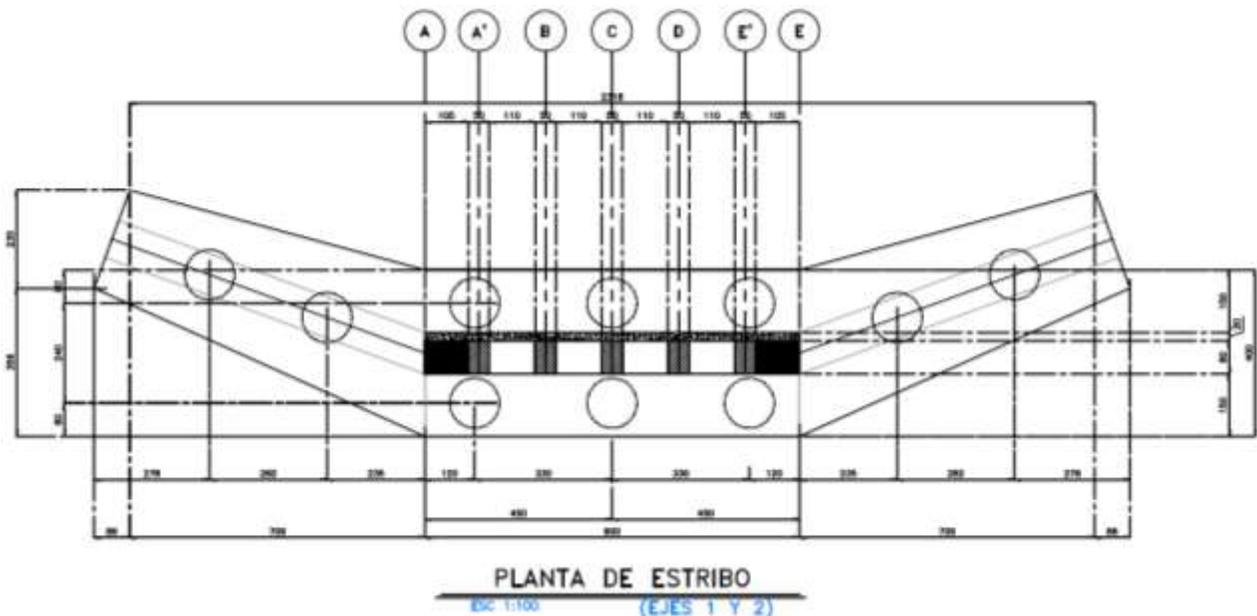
Planta del estribo en el cual se puede apreciar las medidas del muro.
